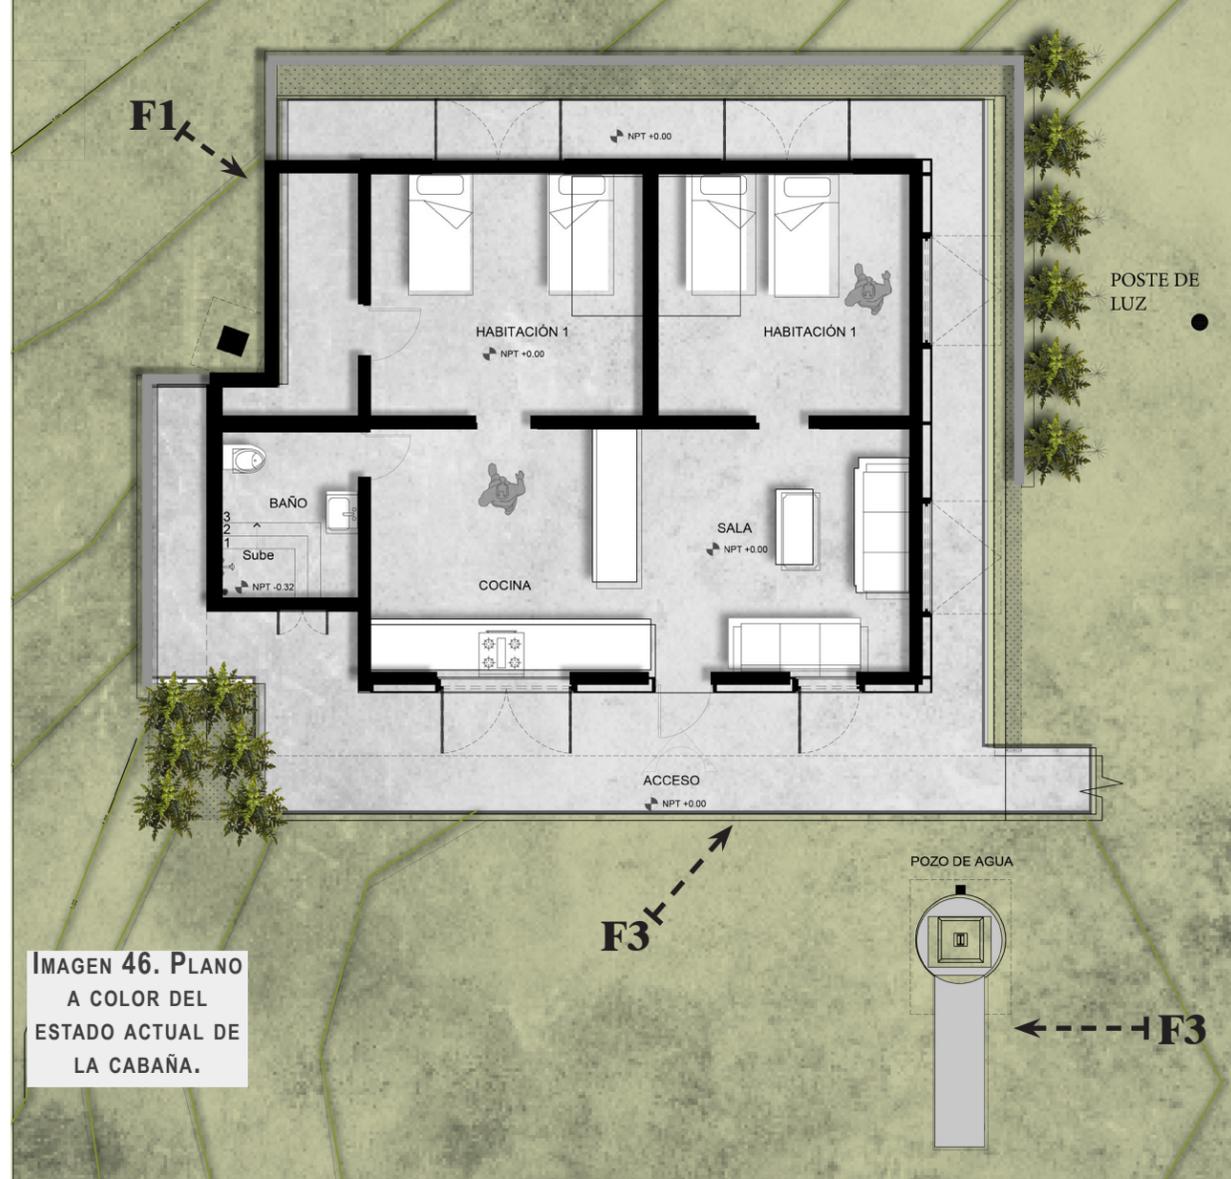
PLANO A COLOR DEL ESTADO ACTUAL DE LA CABAÑA.
